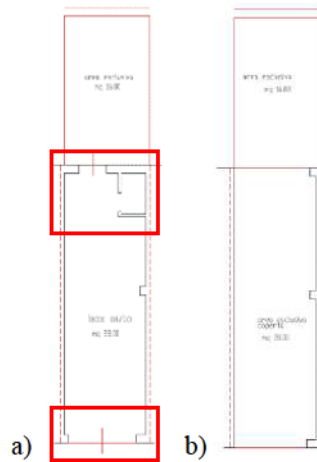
a) Planimetria locale box auto allo stato attuale; b) Planimetria area di pertinenza dopo demolizione
